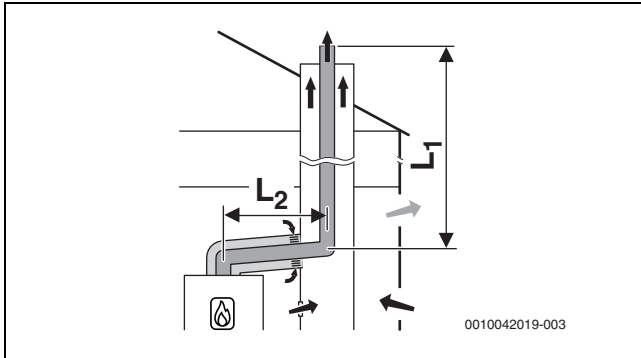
Схема жесткого отвода дымовых газов в шахте согласно В_{53р} с забором воздуха из помещения через концентрический соединительный элемент в помещении для установки; вентиляционное отверстие в шахте
